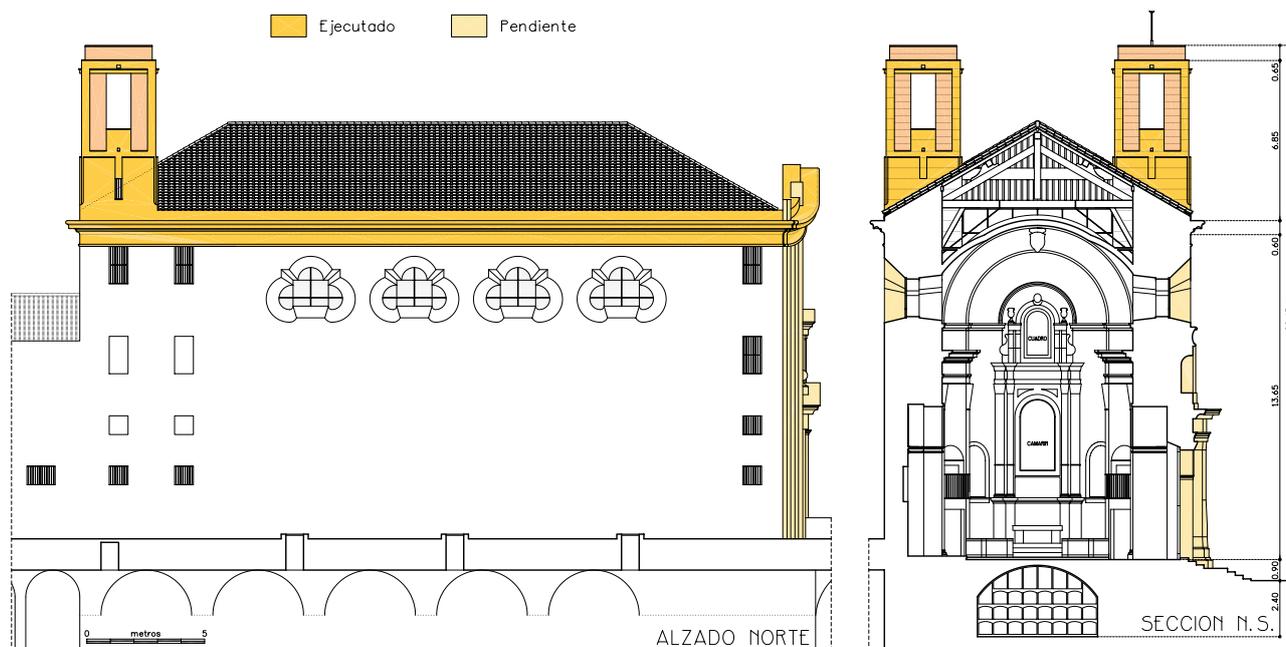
Alzado norte y sección N-S del proyecto pendiente de ejecución (2008-12)
